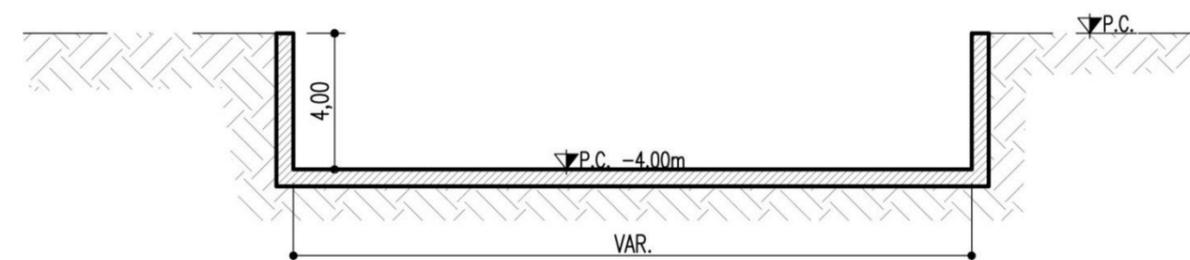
Sezione tipo Canali di trapezoidale e laminazione
